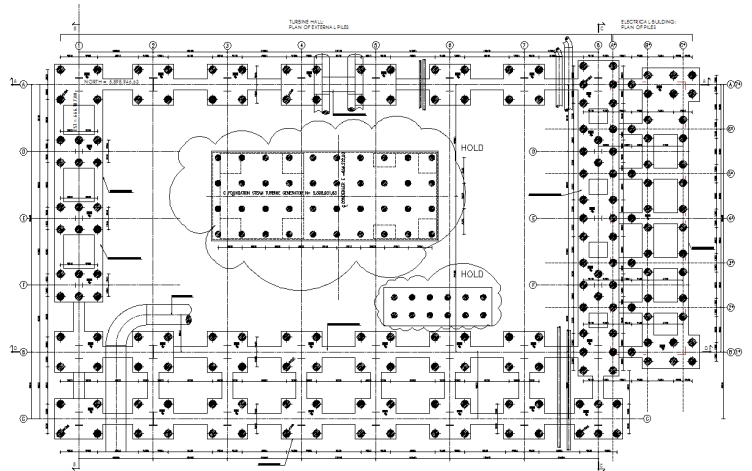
Planta sector Turbine Hall – Steam Turbine (200 pilotes ejecutados).
